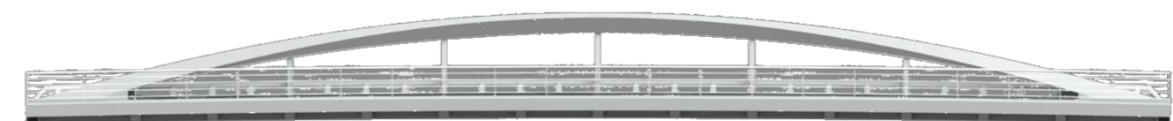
Alzado modelo 3D (Fuente: Elaboración propia)
